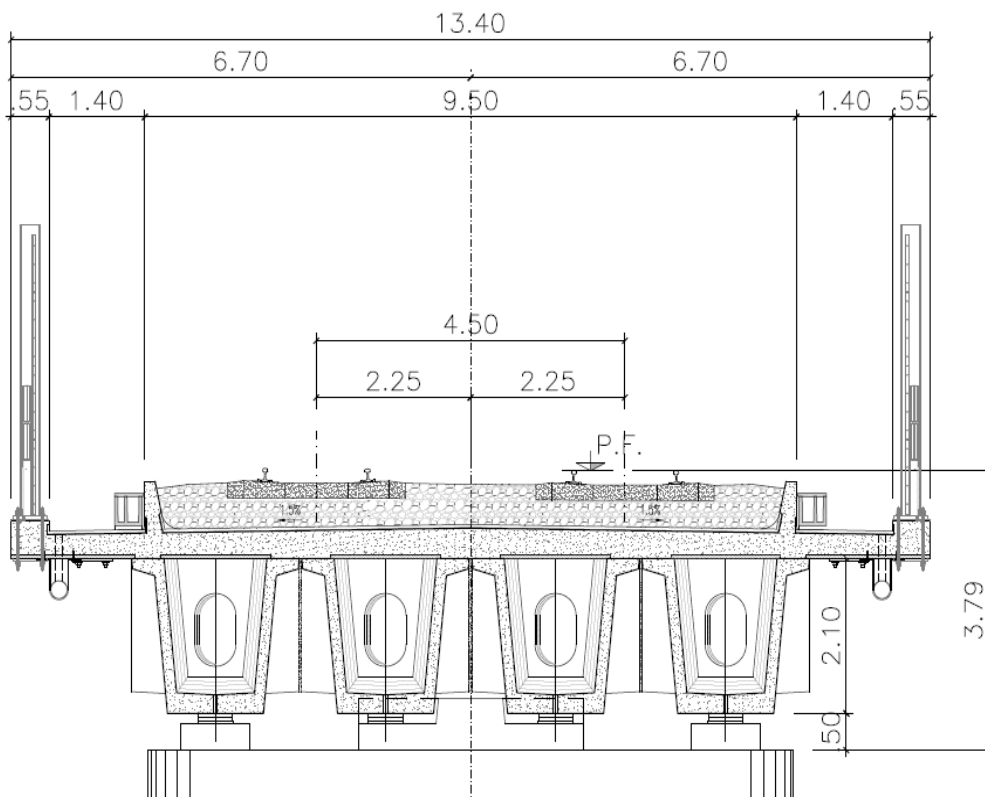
Sezione trasversale tipo dell'impalcato con travi in c.a.p.
